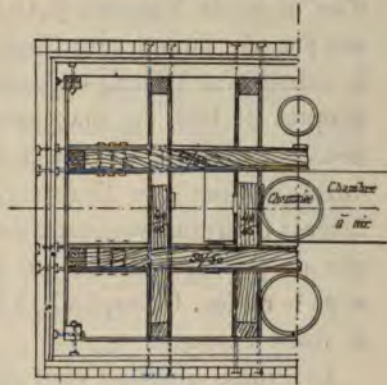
Coupe du caisson suivant AA de la figure 80.
